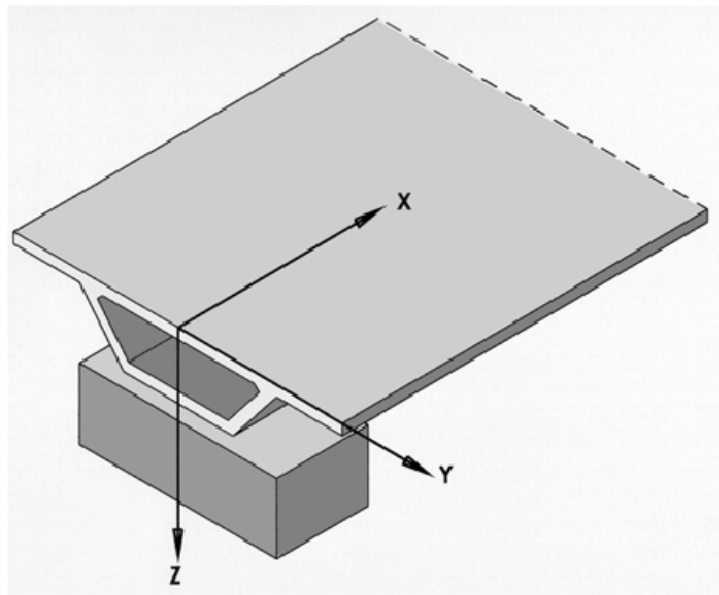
“Orientazione sistema di riferimento rispetto alla struttura completa”
